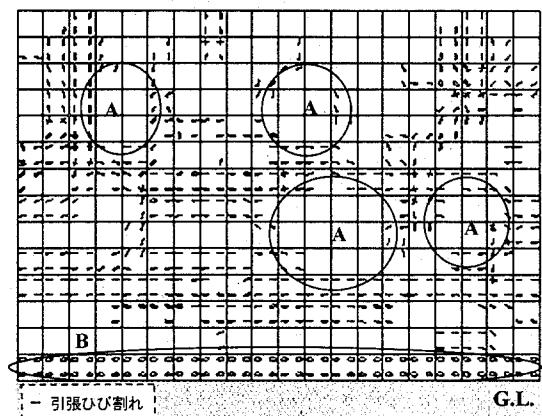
コンクリート表面のひび割れ状況 (数値解析)
